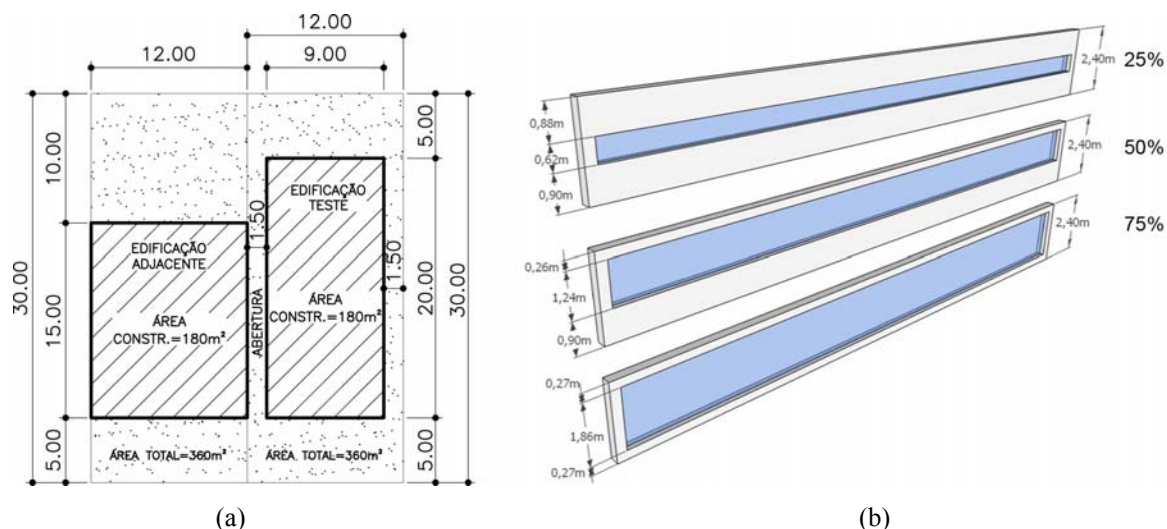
(a) Planta de implantação adotada para edificação teste e edificação adjacente; (b) Diferentes valores de WWR adotados: 25%, 50% e 75%
